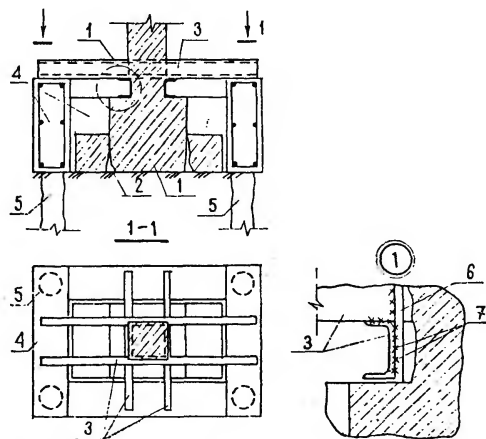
Передача нагрузки от колонны на буронабивные сваи
